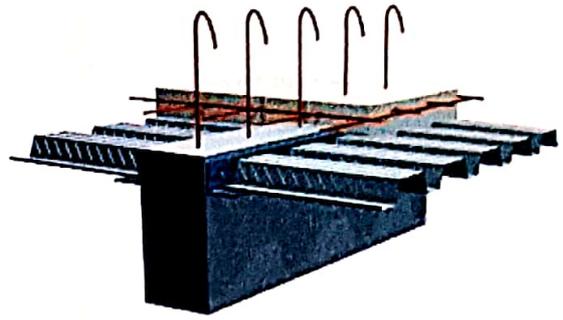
Appui de recouvrement sur poutre ou mur en béton
